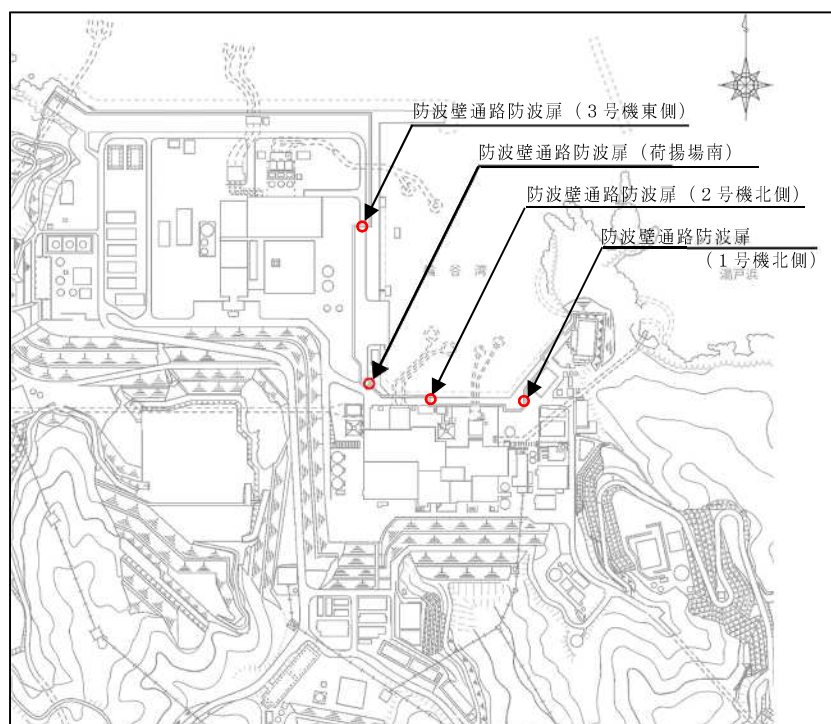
防波壁通路防波扉 位置図（平面図）
